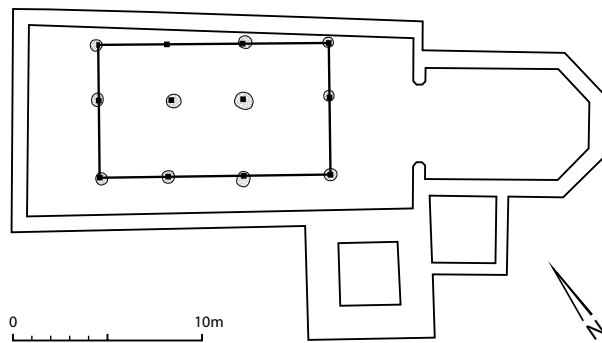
Worb, Kirche. Holzpfeifenbau. Grundriss. M. 1:400.
